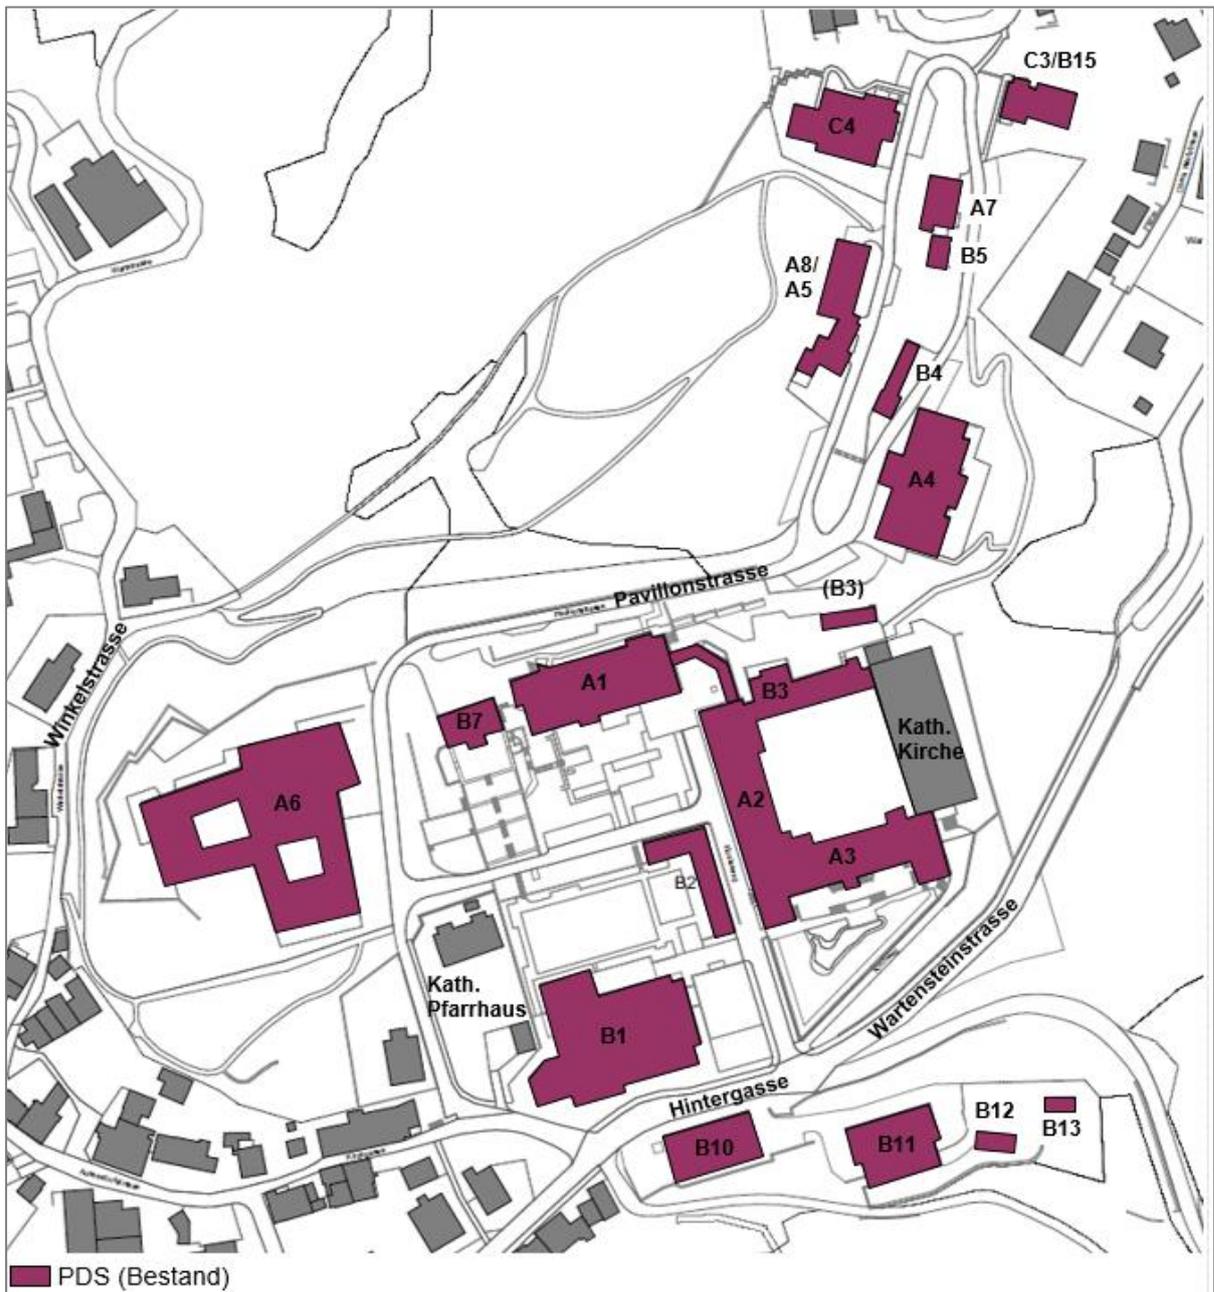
Situationsplan PDS Pfäfers (ohne landwirtschaftlichen Betrieb Bovel B18)
